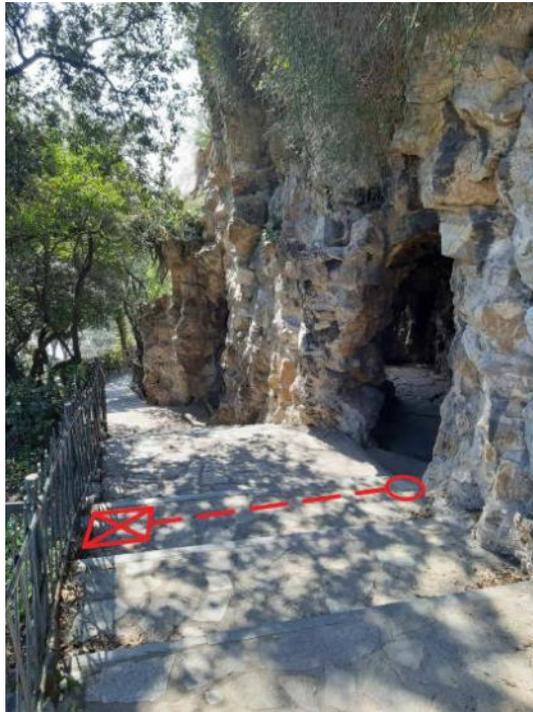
Posizione dei lampioni situati in posizione intermedia sulla scalinata
